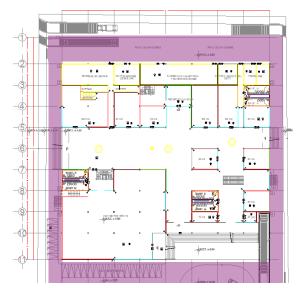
Ubicación en el plano del área libre cubierta de adopasto.
